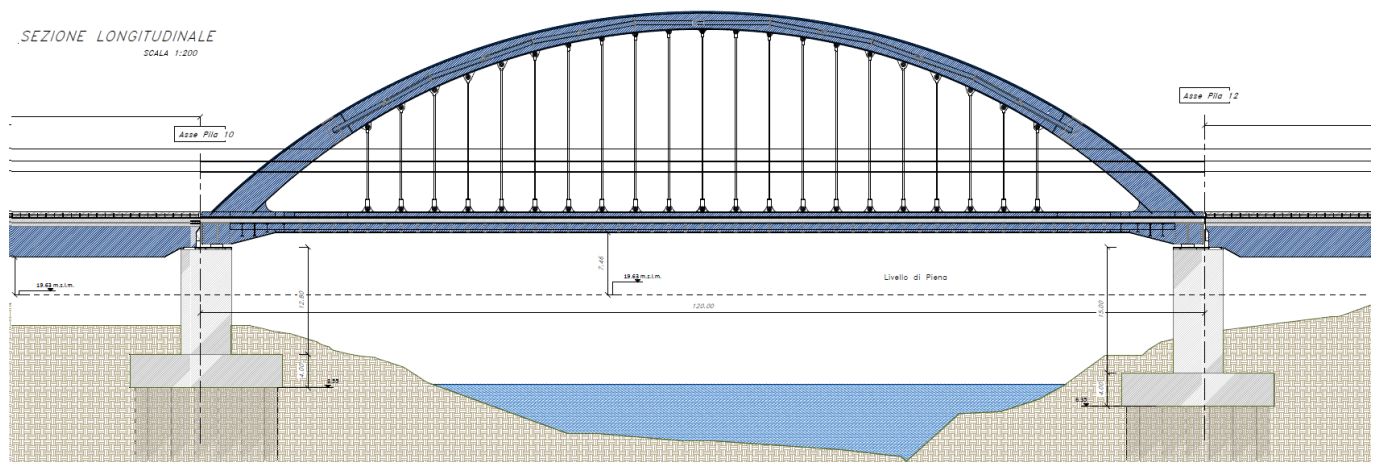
Campata ad arco del VI04 – Sezione longitudinale
